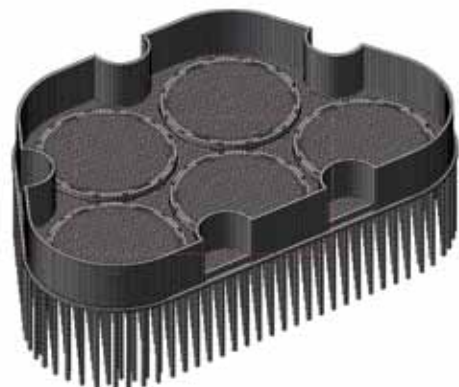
Общий вид монолитной железобетонной чаши и фундамента
